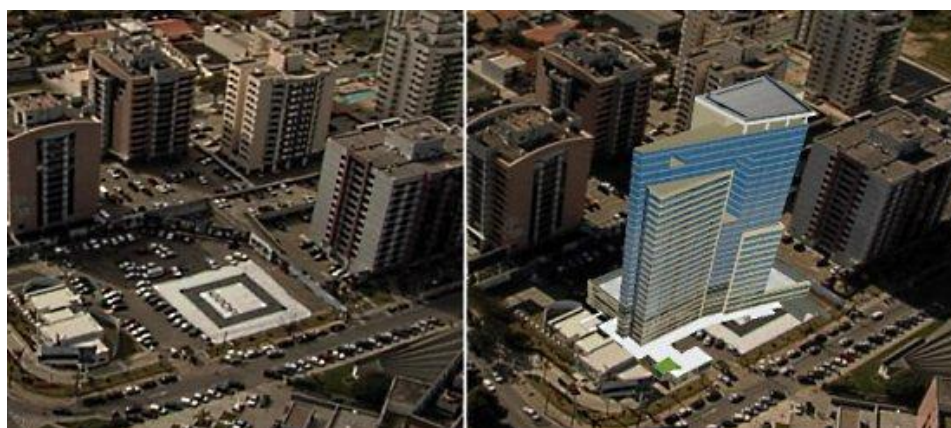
RA a favor da construção civil, Imagem disponível em: <https://goo.gl/7jXnnR>
